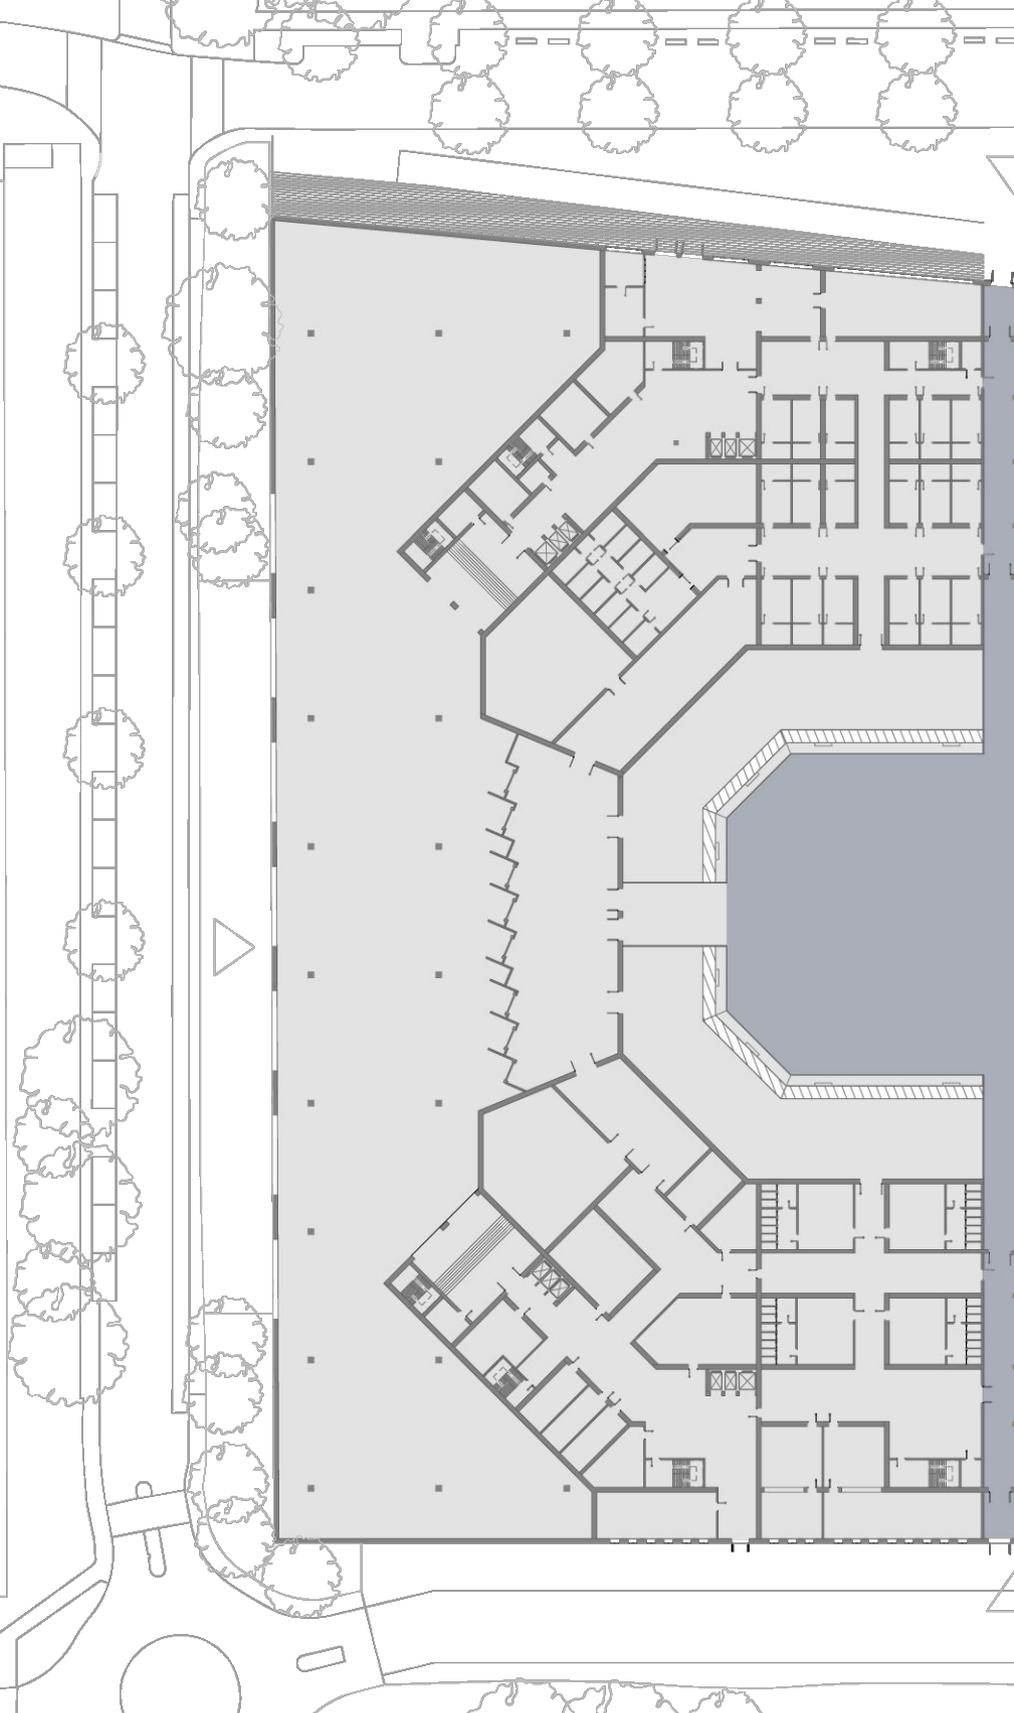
Grundriss EG Gebäudeteilung
